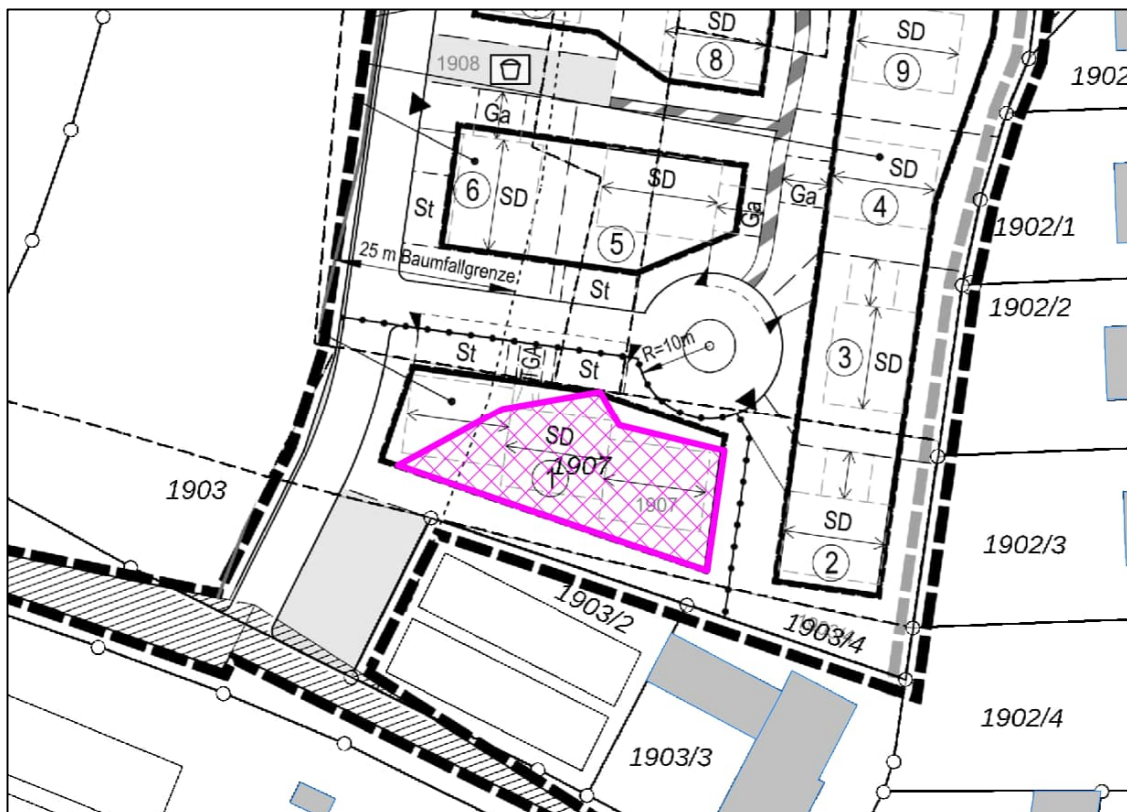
Lageplan mit Darstellung des Bereichs, in dem keine Immissionsorte nach TA Lärm entstehen dürfen
